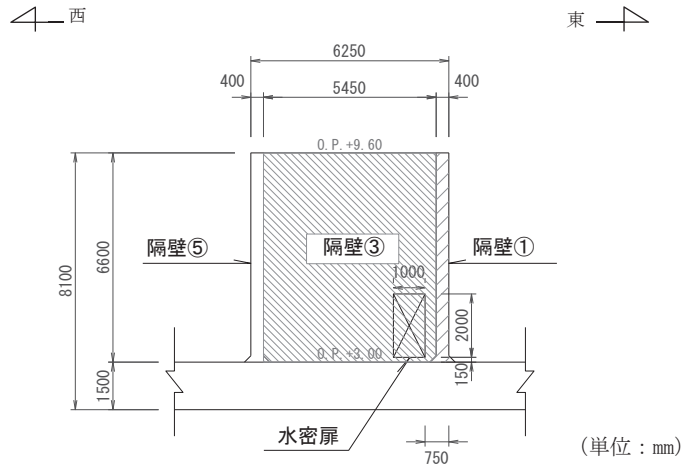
(3) 補機ポンプエリア断面図 (③—③断面)
